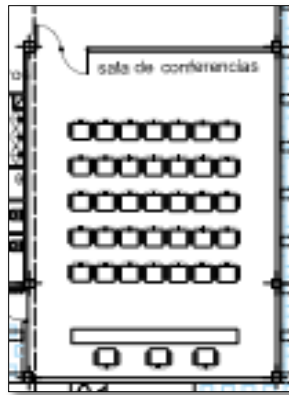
Sala de conferencias planta baja edificio ME-1. (2017)
